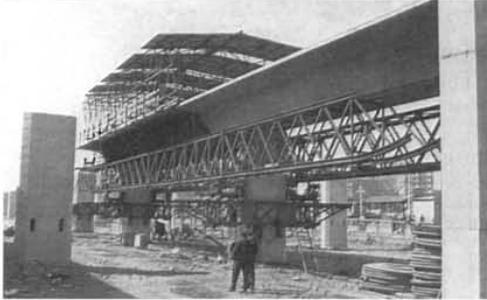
Vista posterior de la cimbra y sistema de apoyo sobre las pilas.
